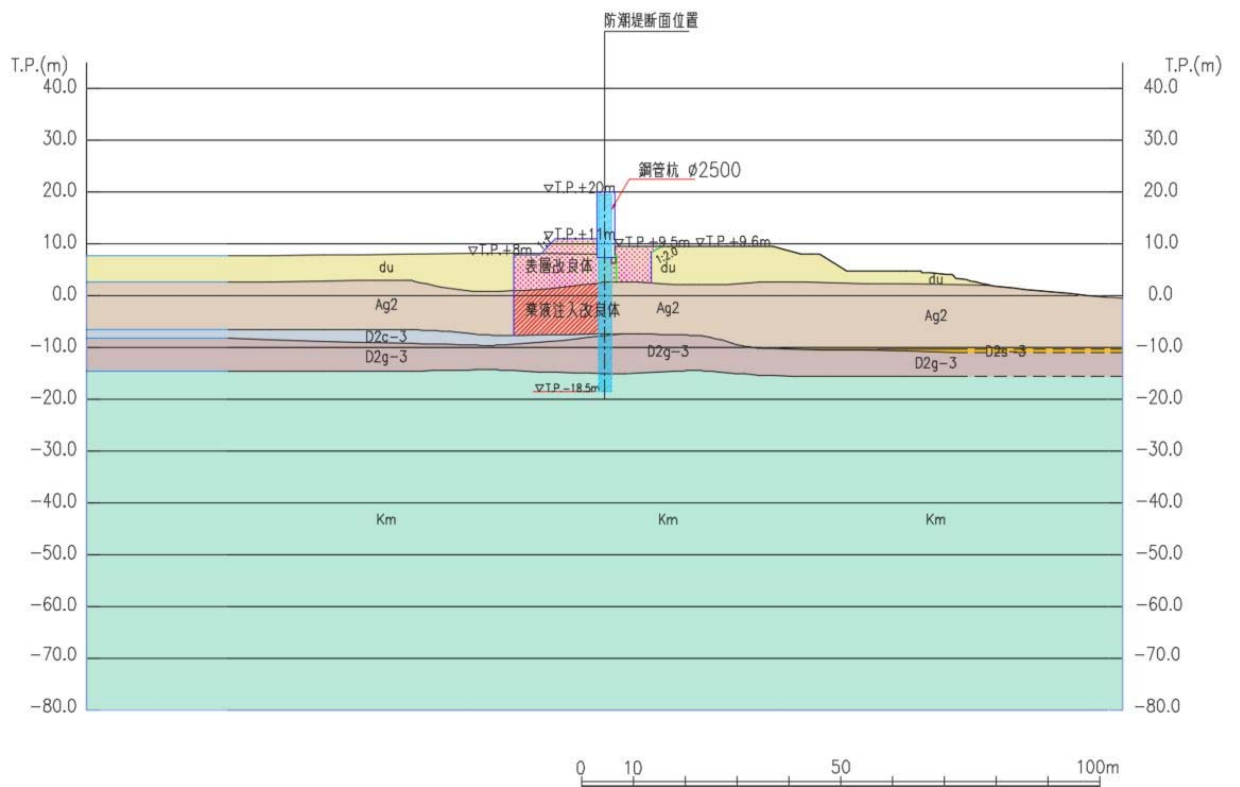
地震応答解析対象断面図 (断面②)
